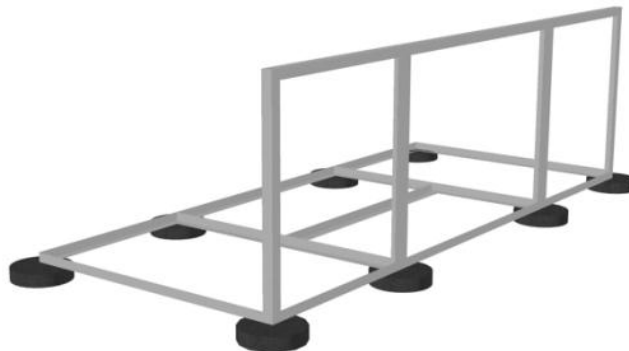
Armado de Vigas de cubierta, sobre columna. Autor: Omar Acuña. 2014.
